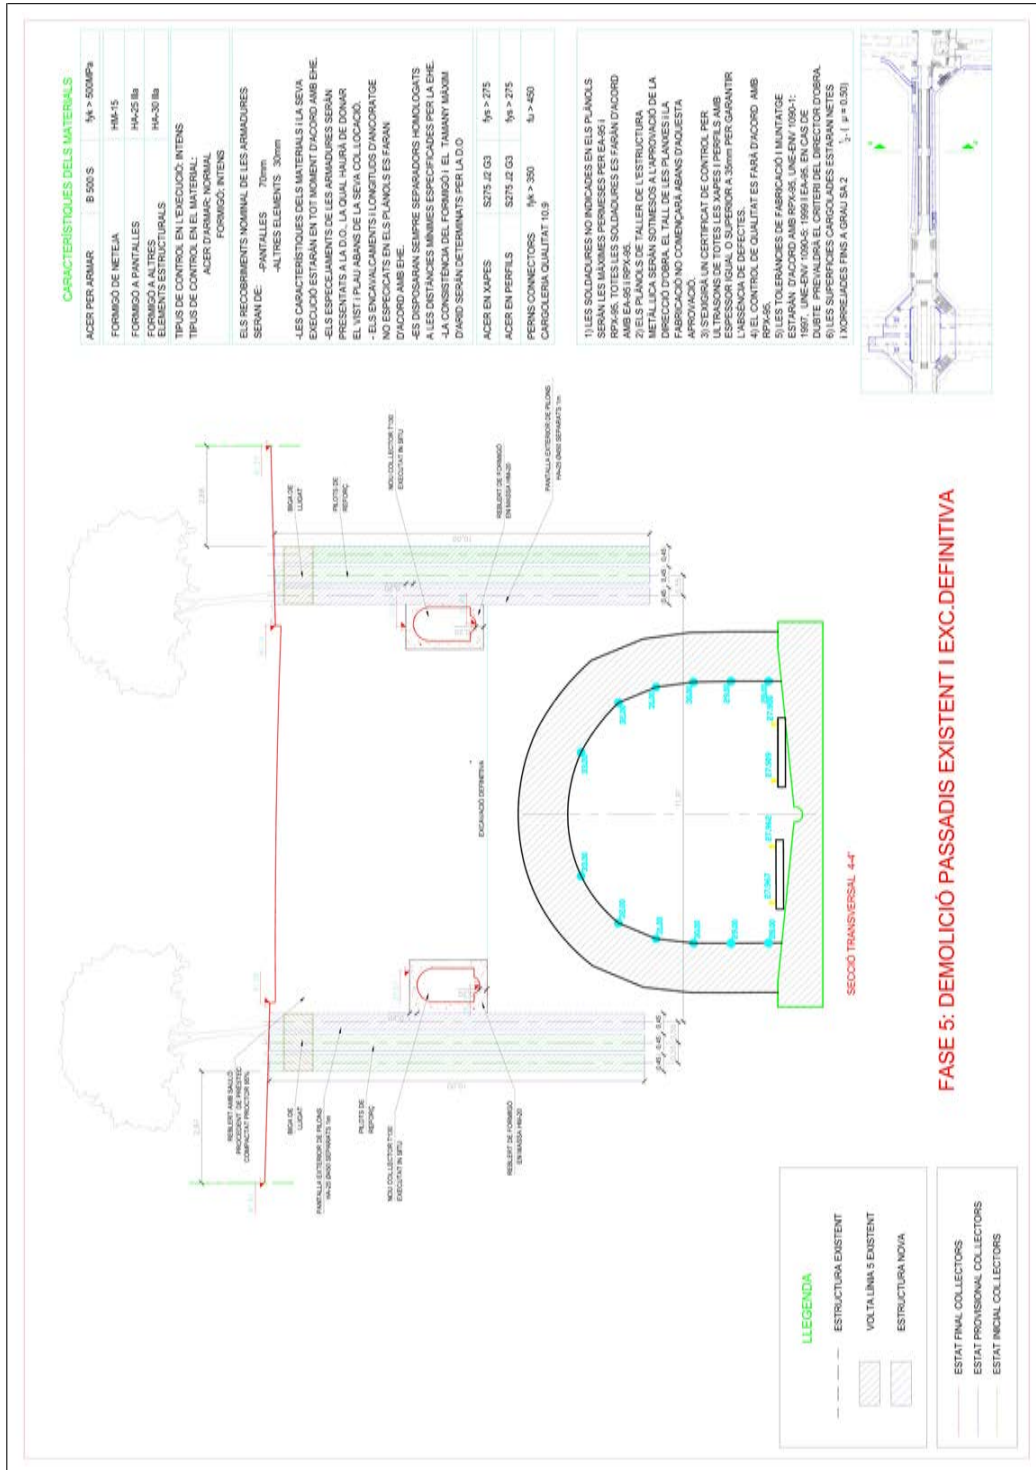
Proceso constructivo - Fase 5: Demolición del túnel existente
